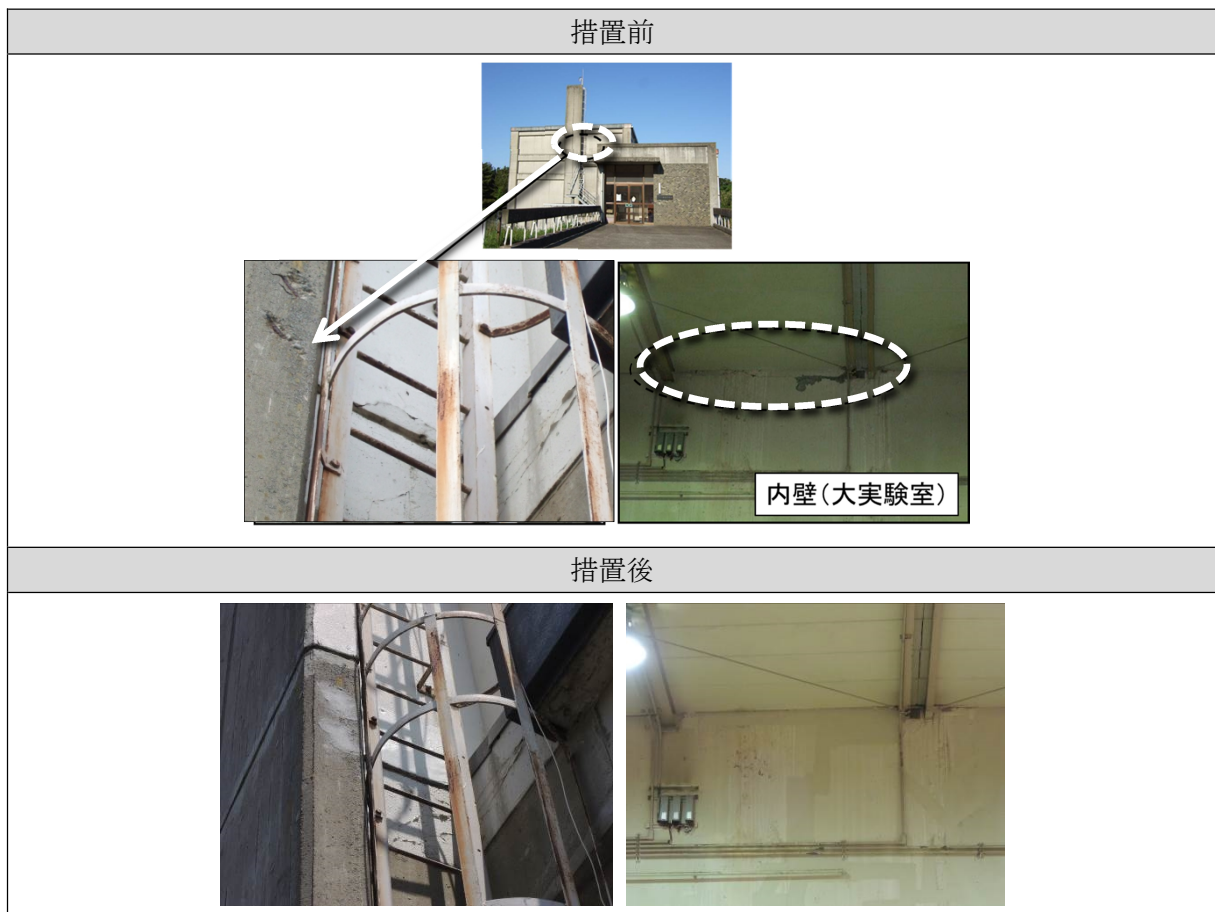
排気筒の外壁及び建家内壁の亀裂
